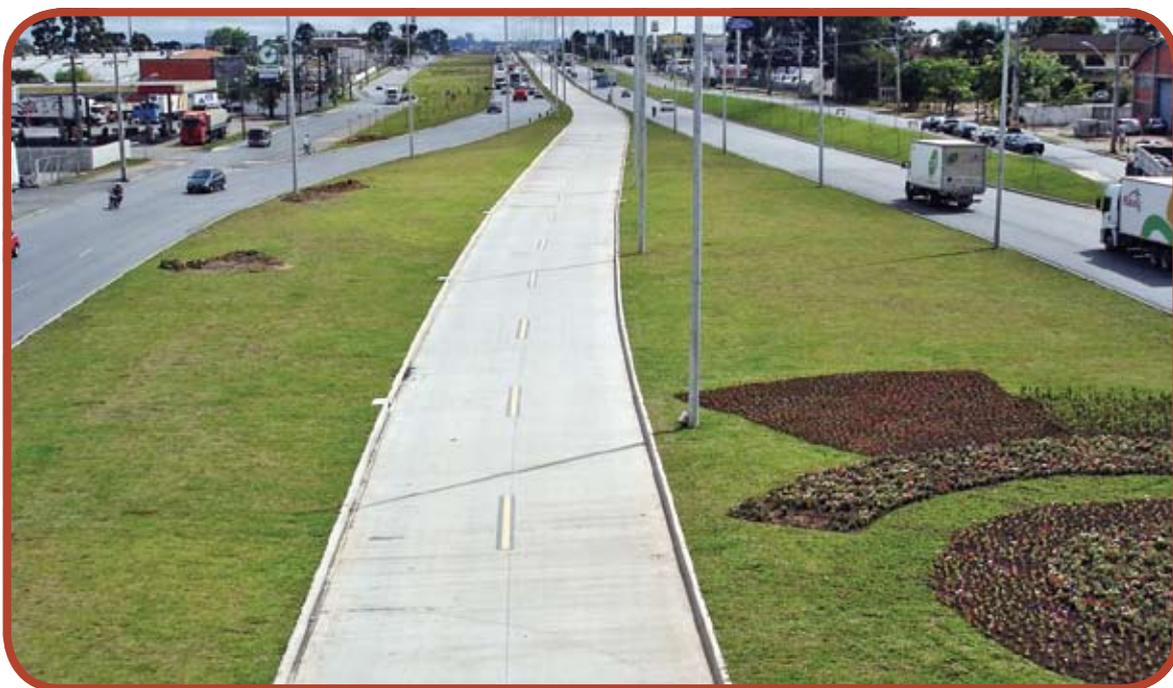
Canaleta exclusiva, ao lado as vias marginais e as vias locais
